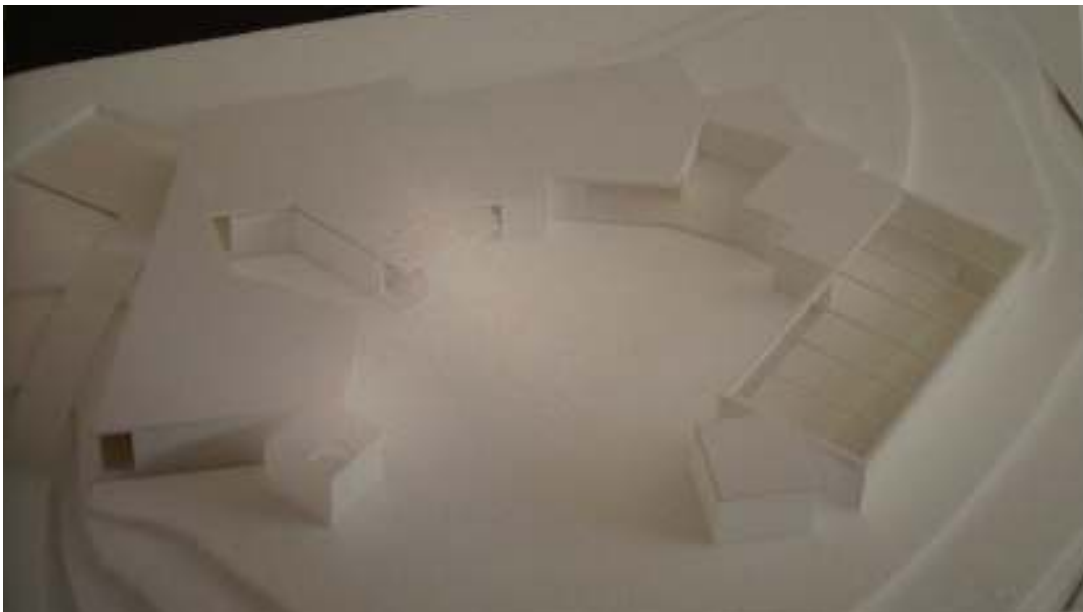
Croqui da implantação do projeto no terreno. Fonte: ELCROQUI (2009)
